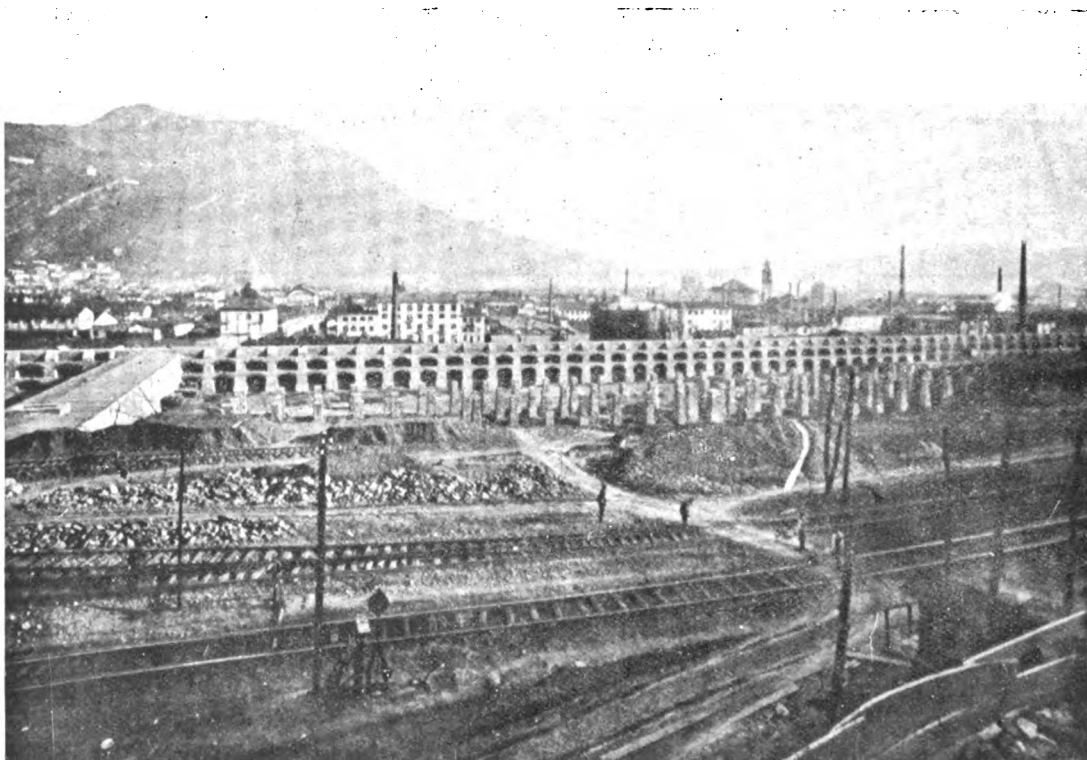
Muraglione di sostegno del piazzale merci. — Pilastrini di fondazione del Magazzino P. V.
